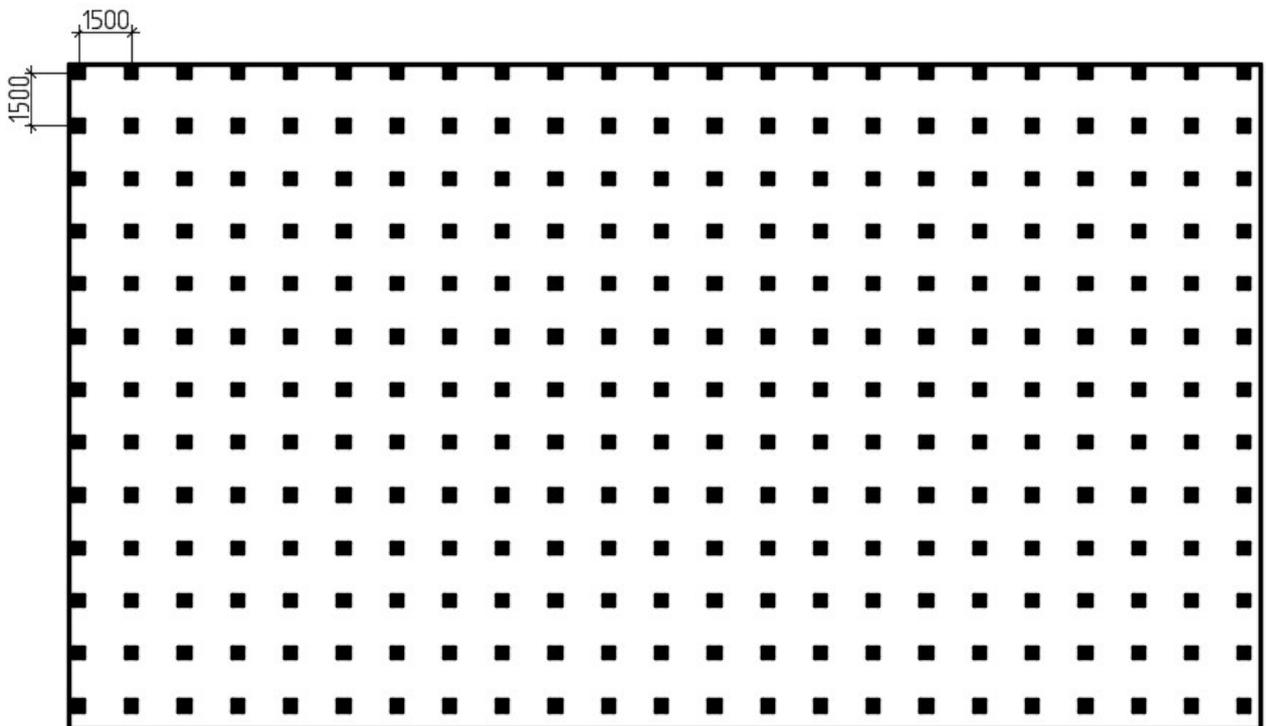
Опалубочный чертеж монолитной плиты фундамента
